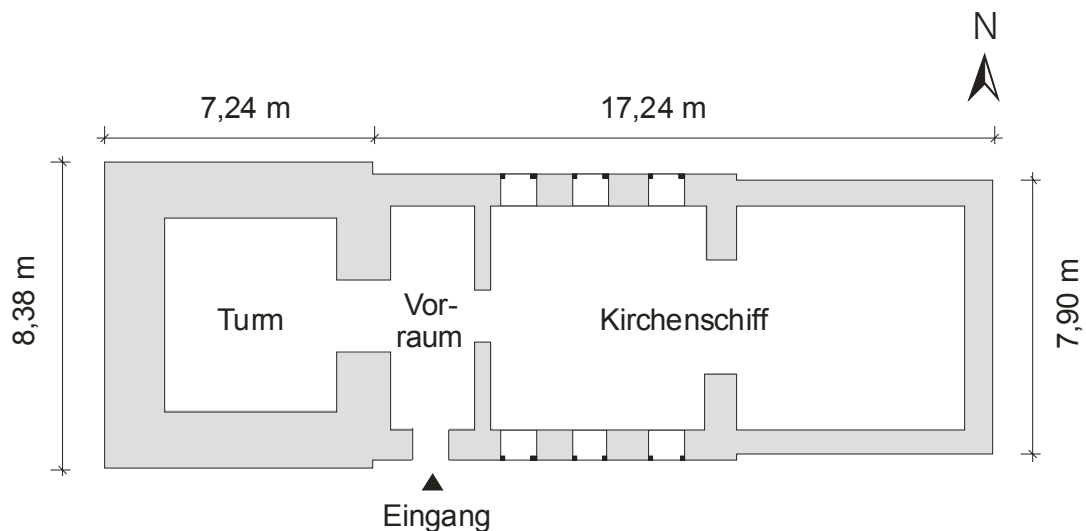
Der Grundriss des Kirchengebäudes in Eilum
